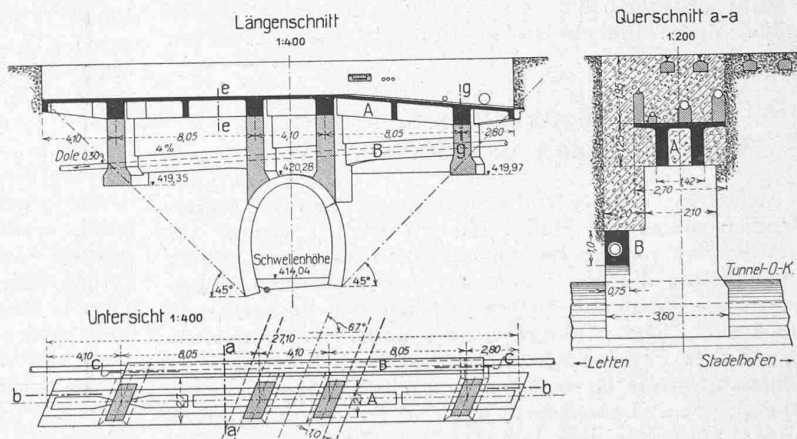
Grundriss, Längs- und Querschnitt der Tunnel-Ueberbrückung.
